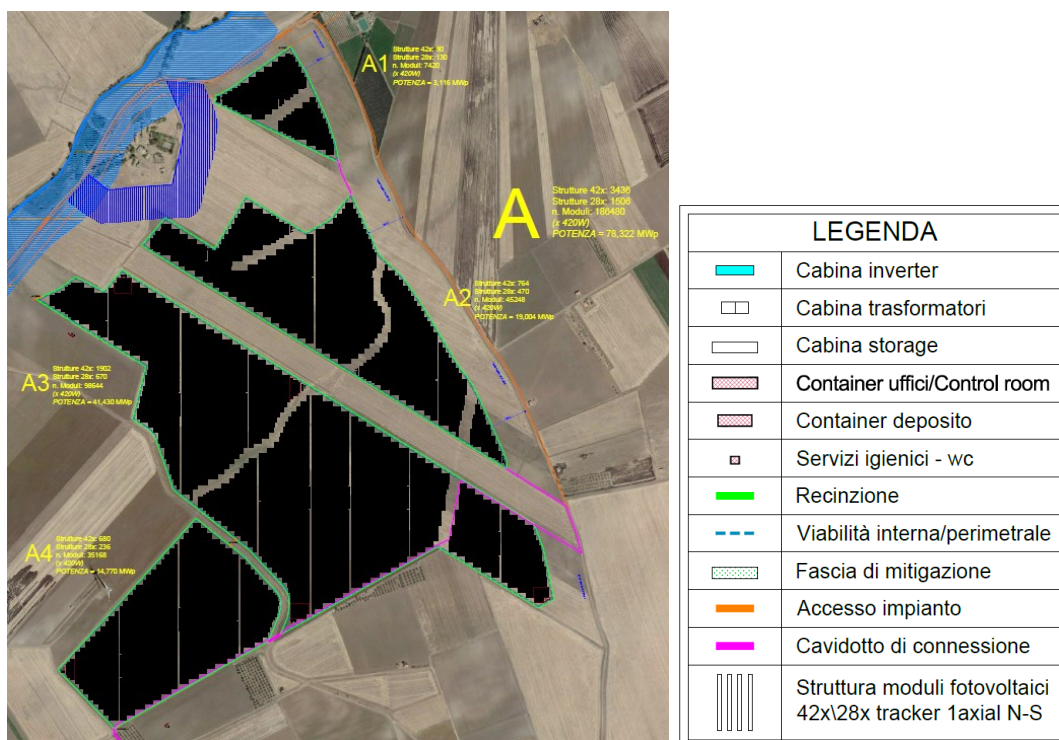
Layout di impianto dell’Area A1-A2 e A3
